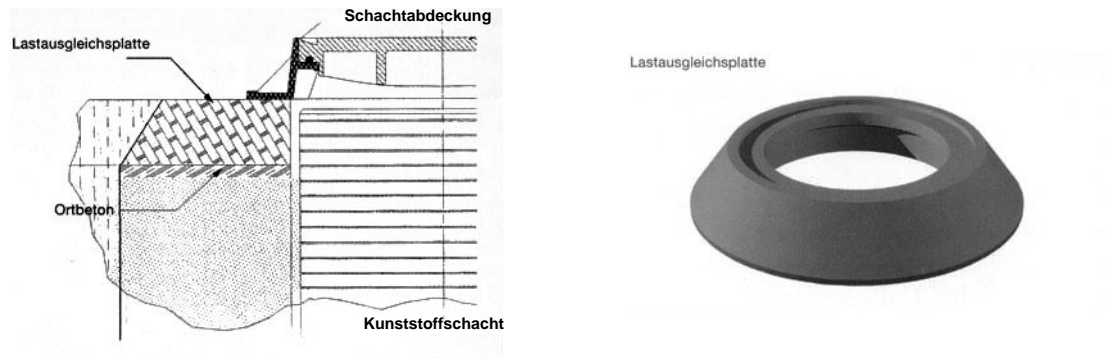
Kunststoffschacht mit Lastausgleichsplatte (nach ALPHACAN)
